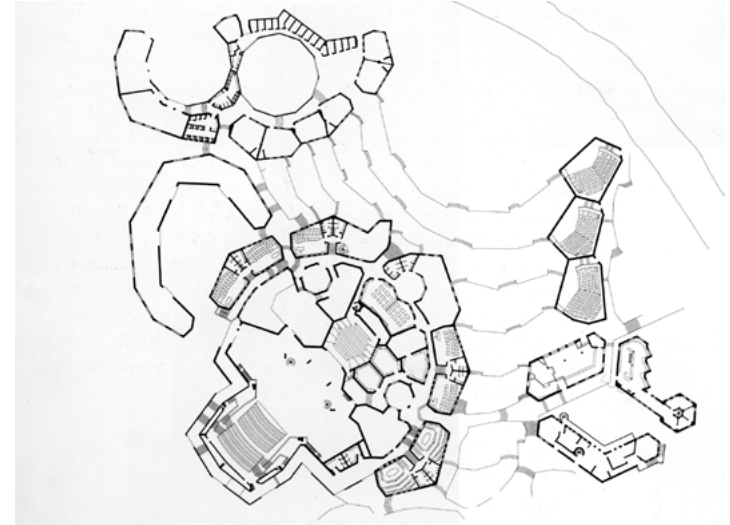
Escuela de Arte Dramático, planta de acceso, Roberto Gottardi
